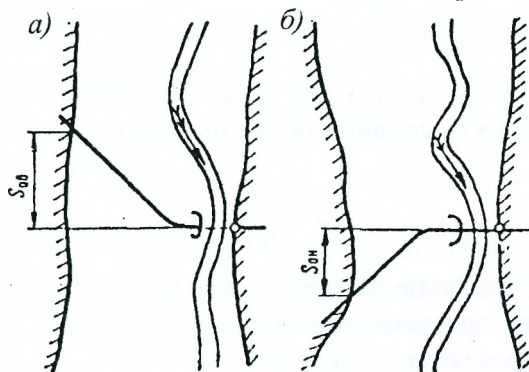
Планы косо́го пересечения потока подходными насыпями: а – с отклонением насыпи вверх по течению; б – то же, вниз по течению
